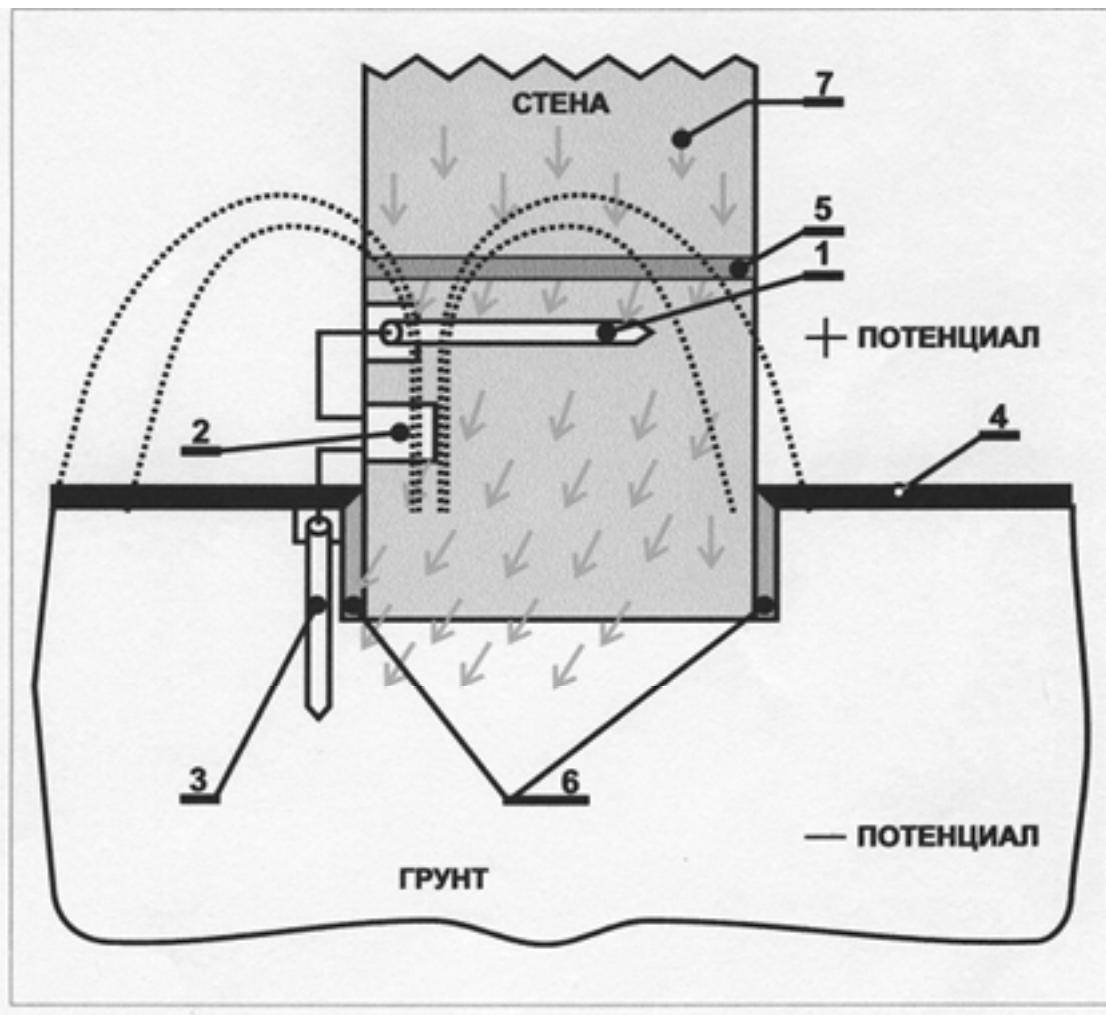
Защитно-ограждающая и осушающая конструкция «Гальваноосмос»: 1 – Стеновой электрод. 2 – Прибор. 3 – Грунтовый электрод. 4 – Отмостка здания. 5 – Горизонтальная гидроизоляция. 6 – Вертикальная гидроизоляция. 7 – Влага, выводимая в грунт под фундамент здания.
